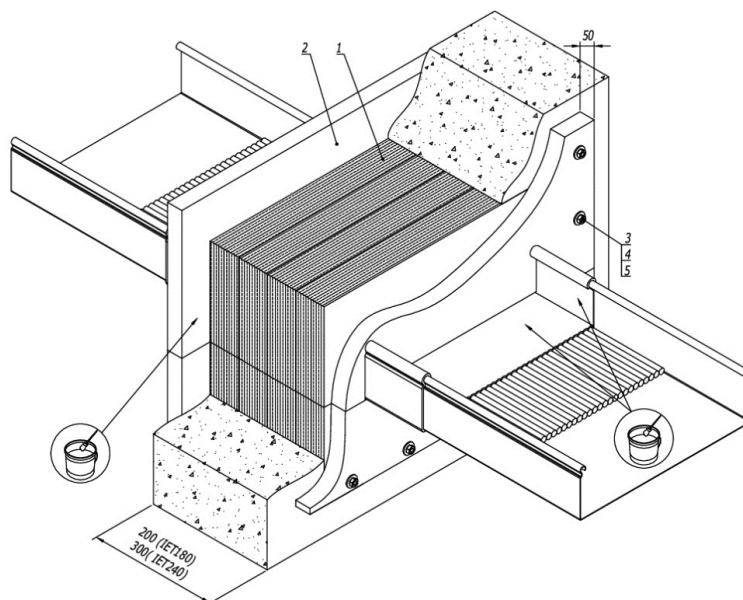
Схема монтажа проходки на основе плит DP и DG
